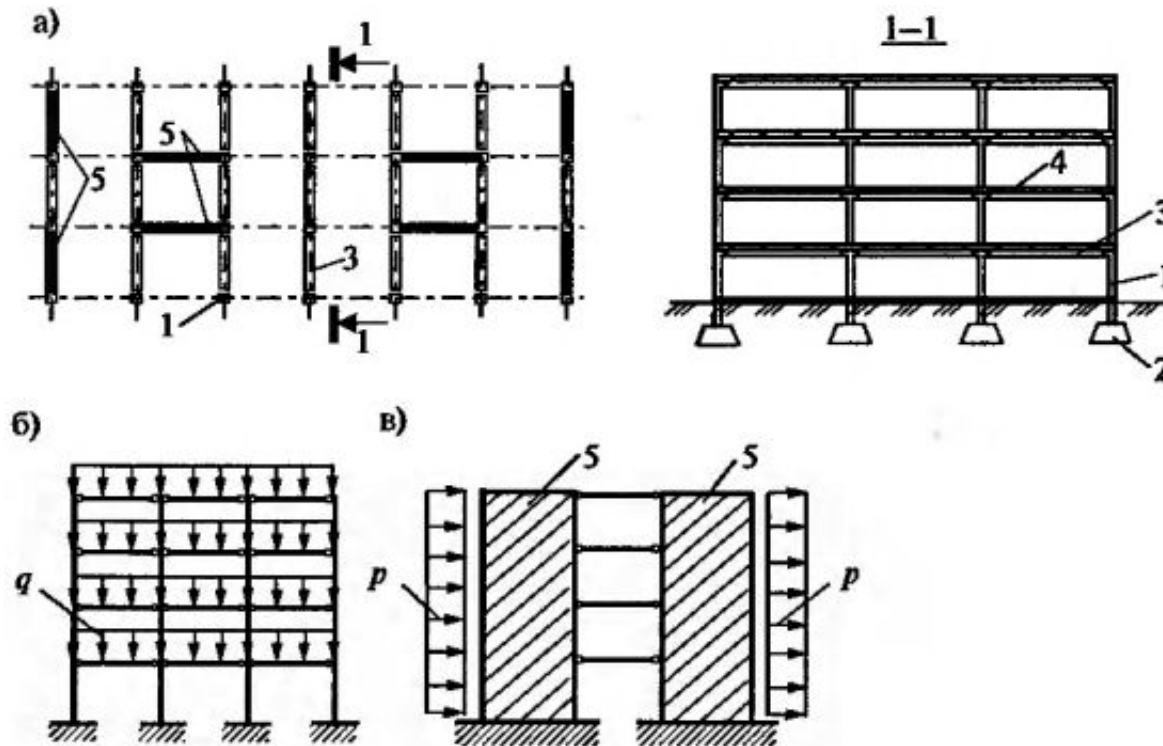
Связевой каркас здания: а) план здания, разрез;
